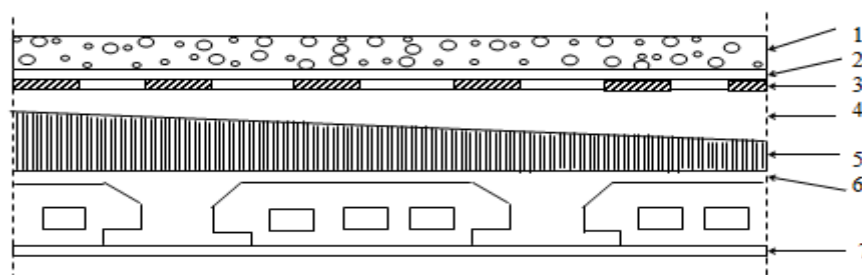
Coupe verticale du plancher terrasse à corps creux.
